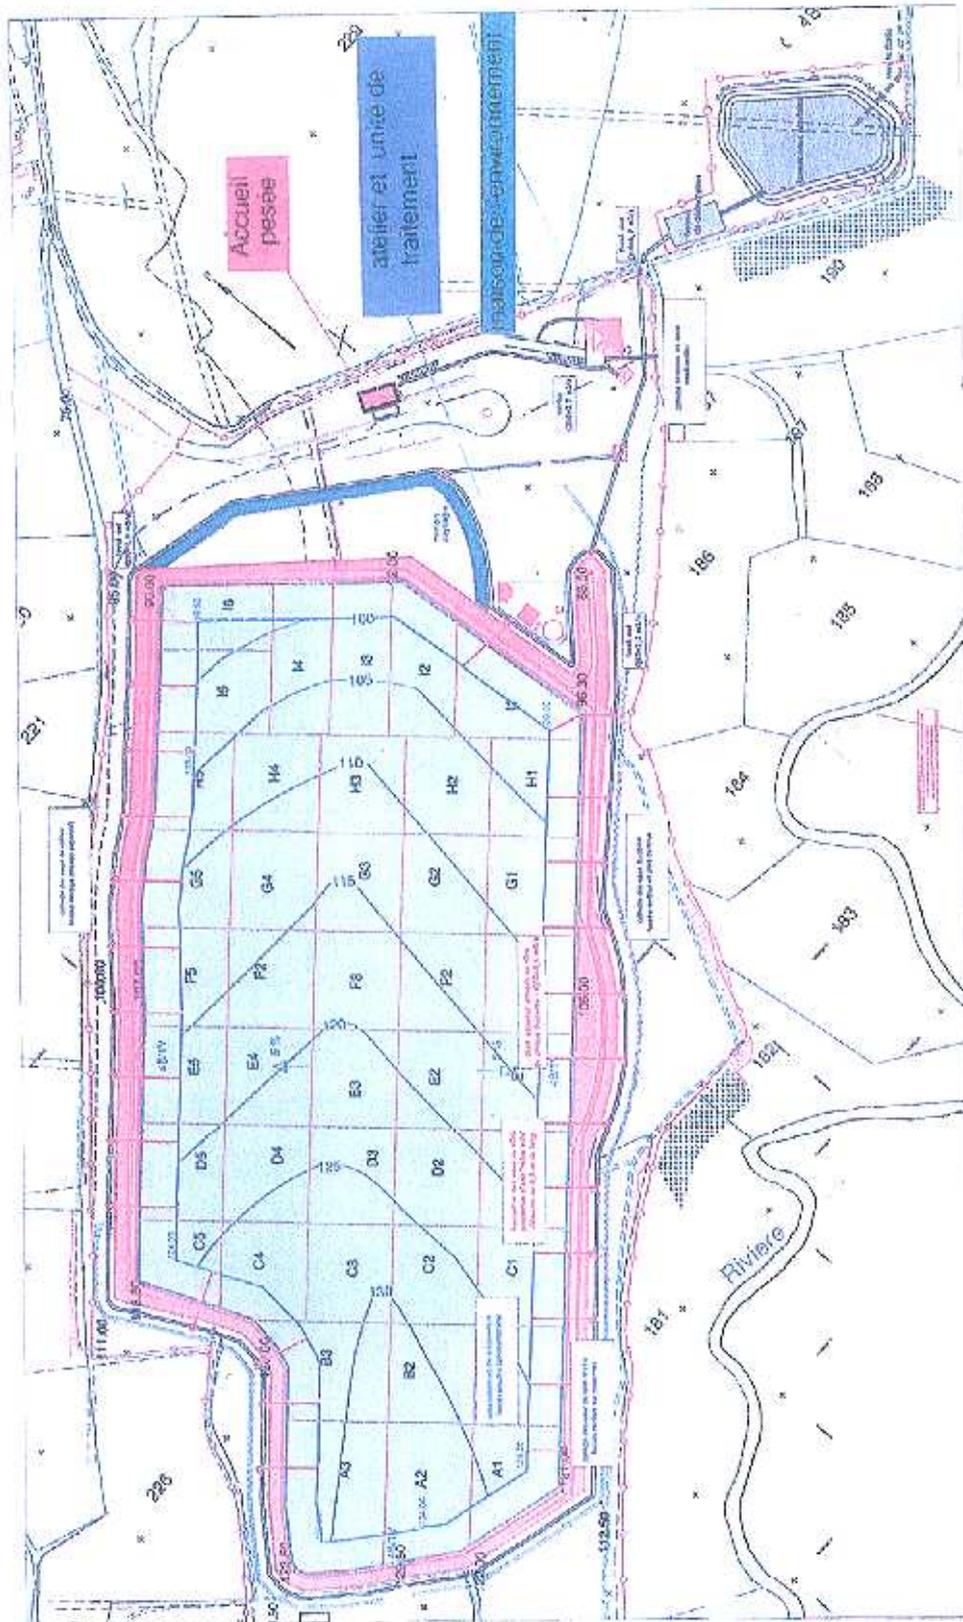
Plan de principe du réseau de collecte des eaux pluviales à 1/3000
